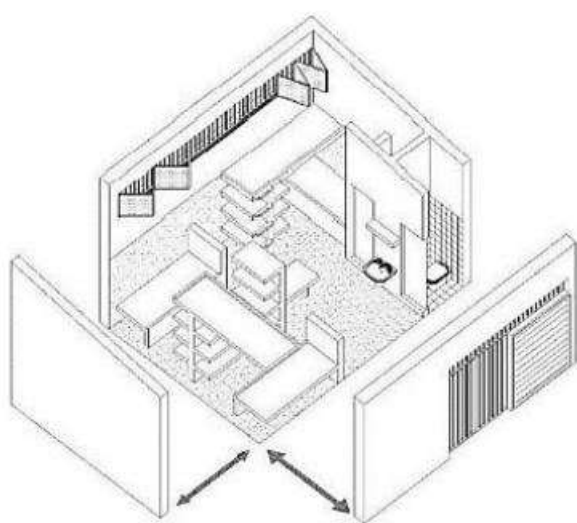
Planta Baixa Dormitório - APAC Santa Luzia.
